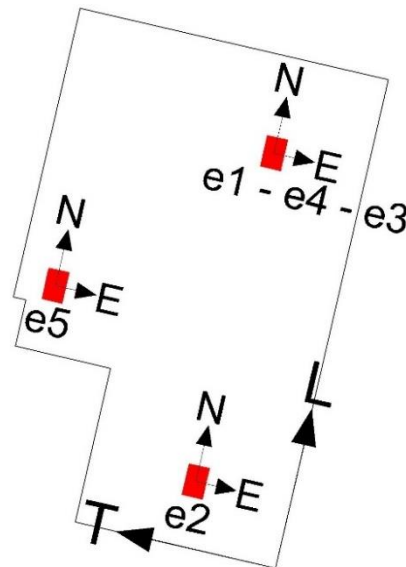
Vista en planta del edificio N°2. Ubicación, orientación y numeración de equipos utilizados
